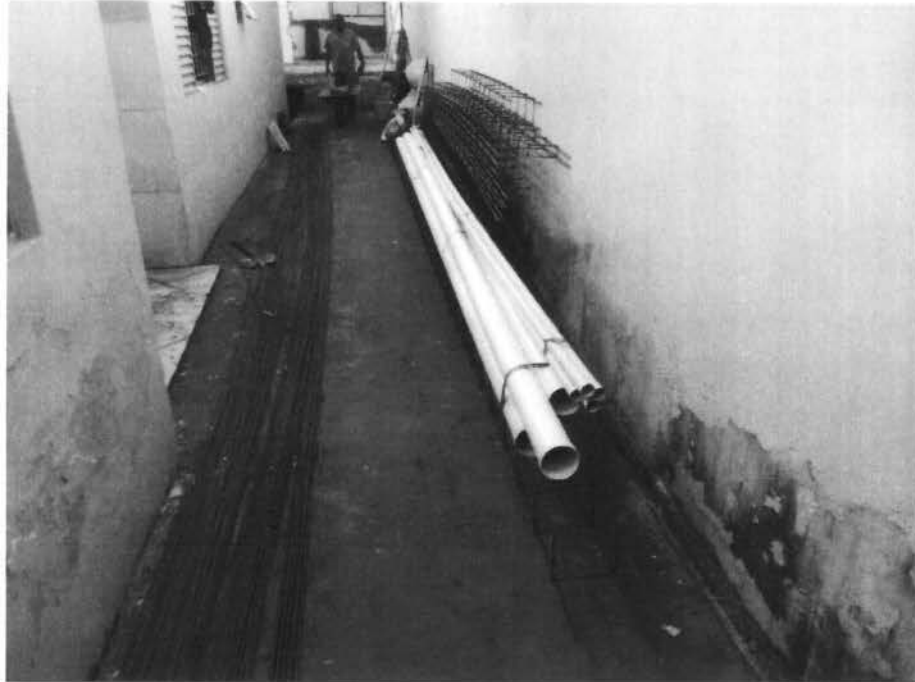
Montagem das colunas e vigas em aço CA-50.
